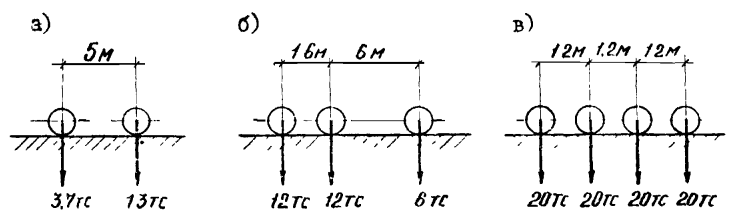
Схемы временных нагрузок на поверхности грунта для колодцев.
